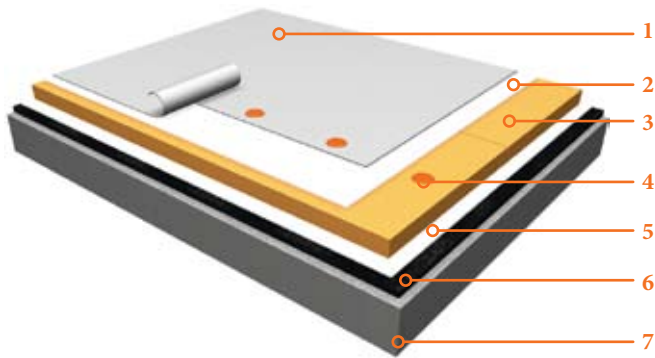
Кровля с механическим креплением гидроизоляционного слоя:
